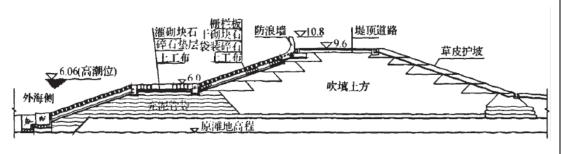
下穿长兴岛海塘大堤结构断面示意图
